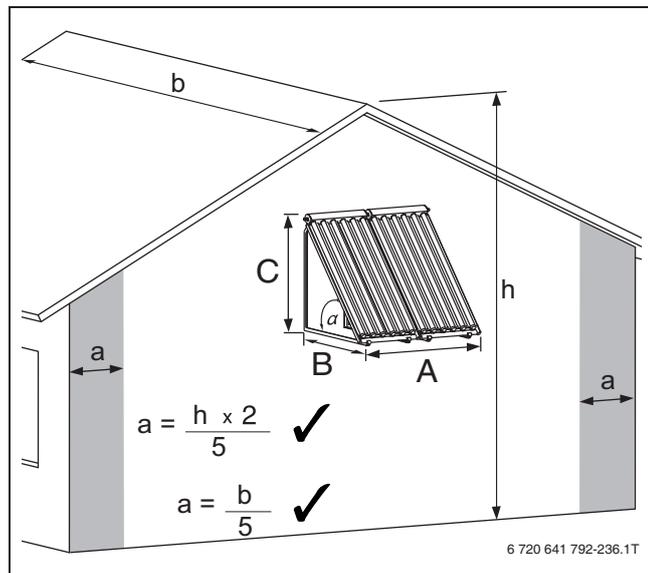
Fabbisogno di spazio per il montaggio su facciata di collettori a tubi sottovuoto SKR6/SKR12 (spiegazione nel testo)
